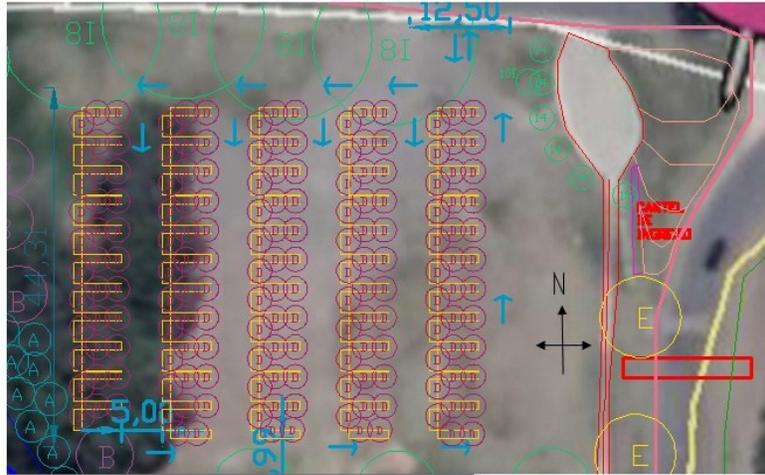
Plano del proyecto de estacionamiento. Autoría propia.
